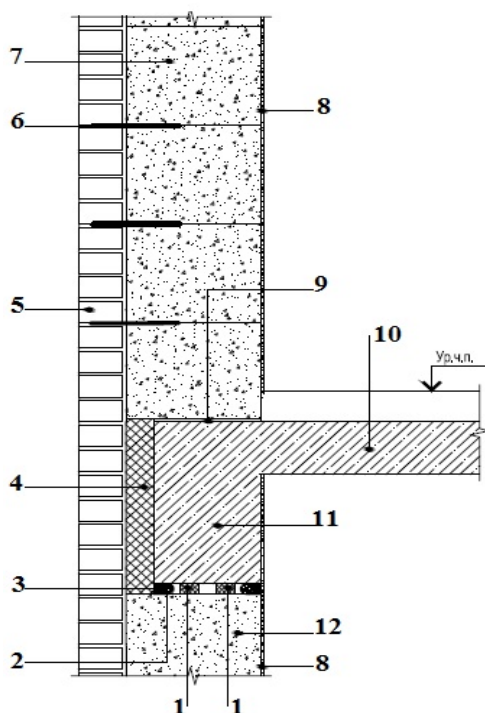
Наружная стена из газобетонных блоков с облицовкой и опиранием на монолитный железобетонный ригель каркаса (каркасно-монолитное строительство): 1 — минераловатная плита; 2 — пороизол (гернит); 3 — герметизирующая нетвердеющая мастика; 4 — эффективный утеплитель; 5 — кладка из лицевого кирпича, 120 мм; 6 — металлическая связь фирмы Bever; 7 — блоки YTONG; 8 — внутренняя отделка; 9 — выравнивающий раствор; 10 — монолитное железобетонное перекрытие; 11 — железобетонный ригель; 12 — доборные блоки
